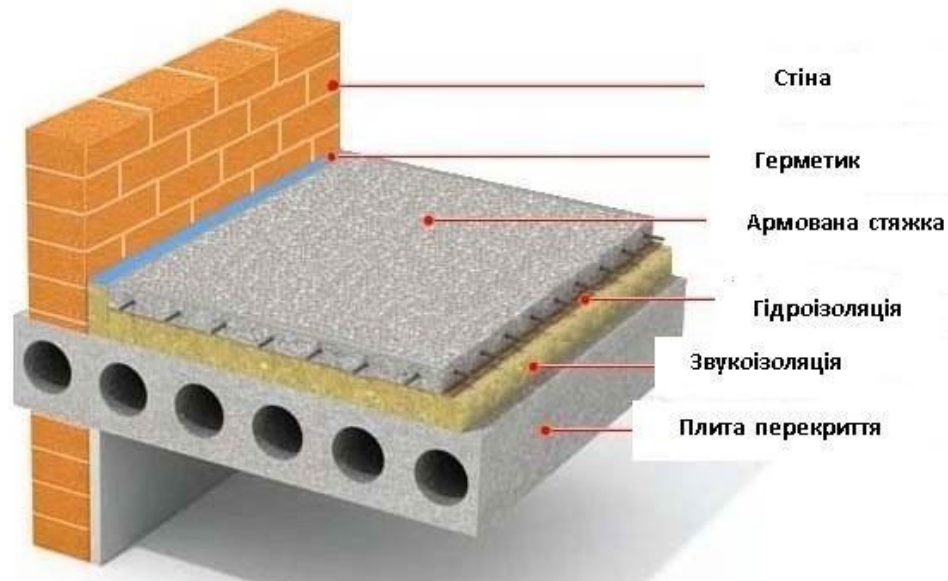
Схема монолітного перекриття із армованою залізобетонною підлогою зі спеціальним покриттям
